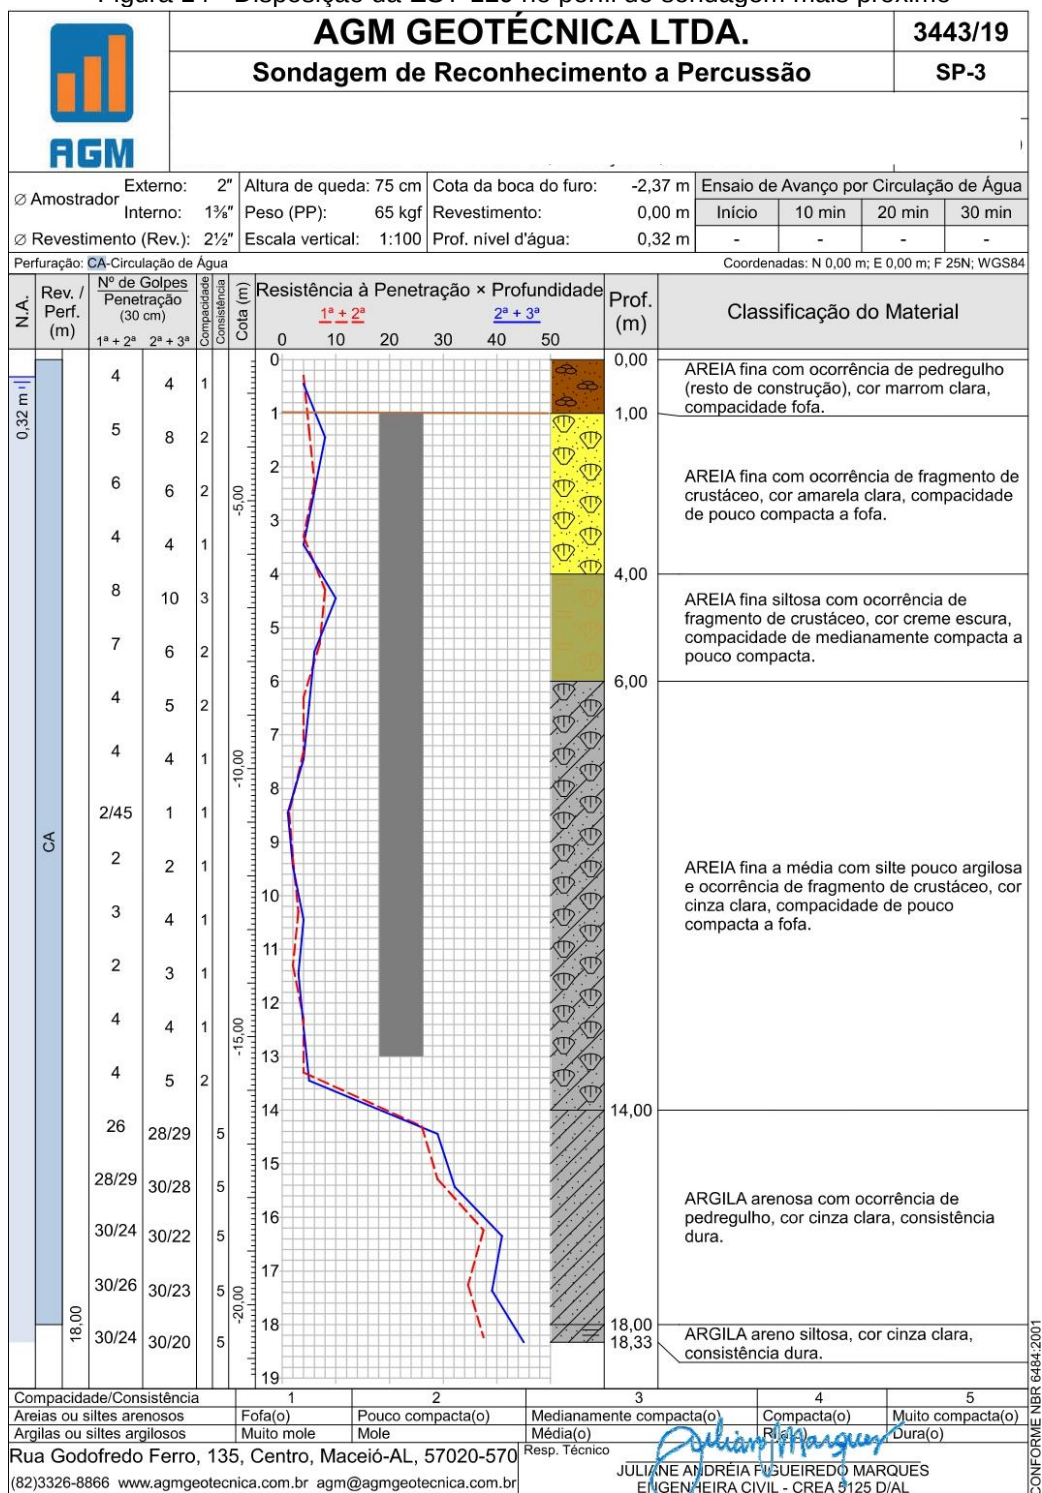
Disposição da EST-74 no perfil de sondagem mais próximo
